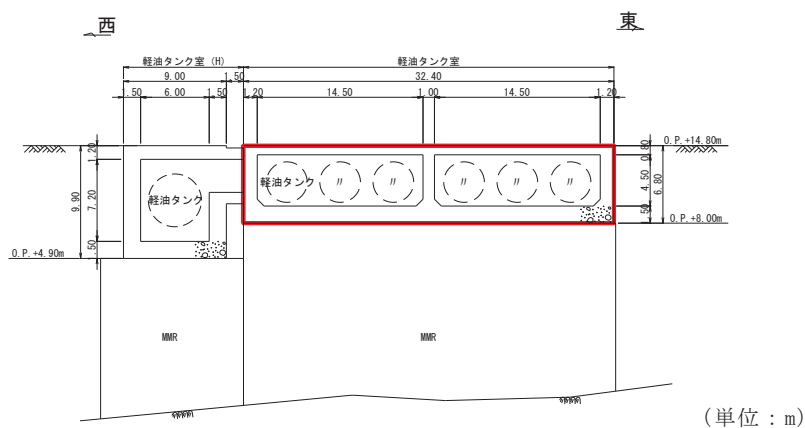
軽油タンク室断面図 (B-B 断面, 東西 (タンク室))
